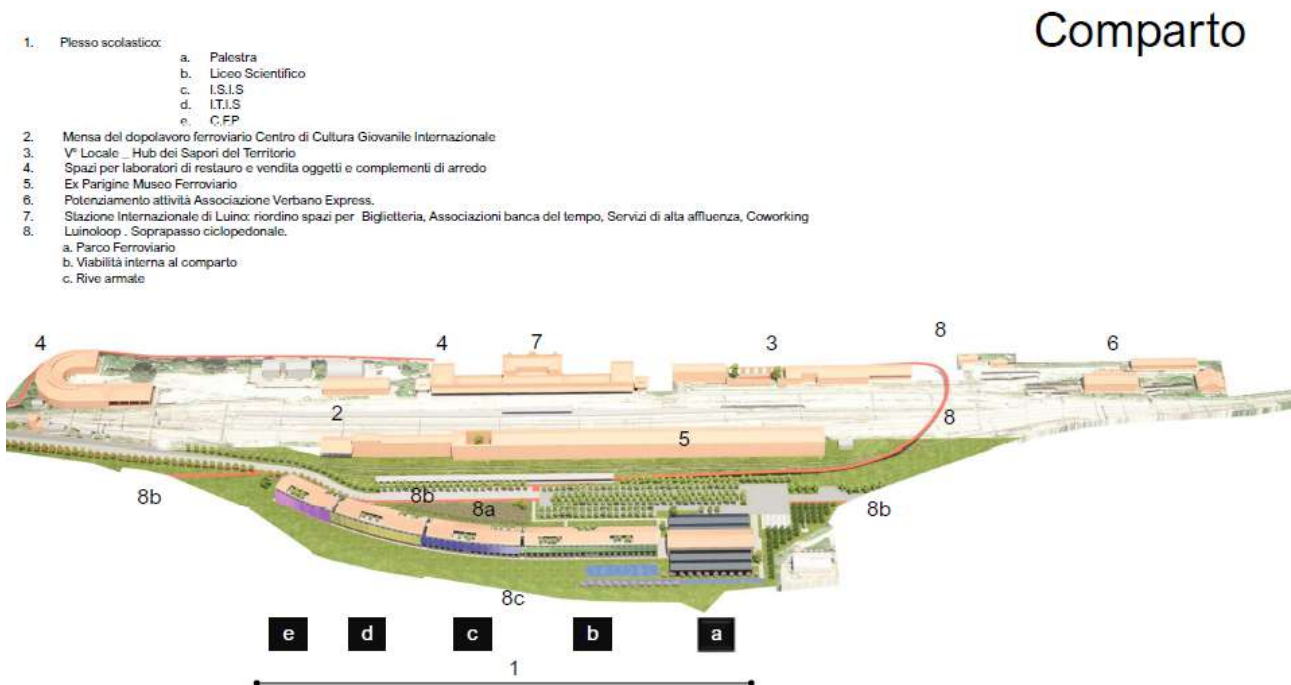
Estratto Masterplan - planimetria generale proposta di intervento progetto a cura dell'Arch Tagliabue Corrado.
